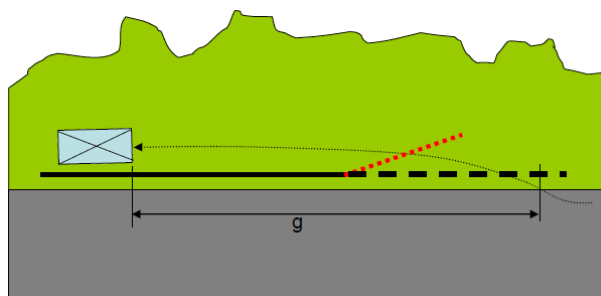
Soluções de projeto de terminais, projeto RISER [22]
